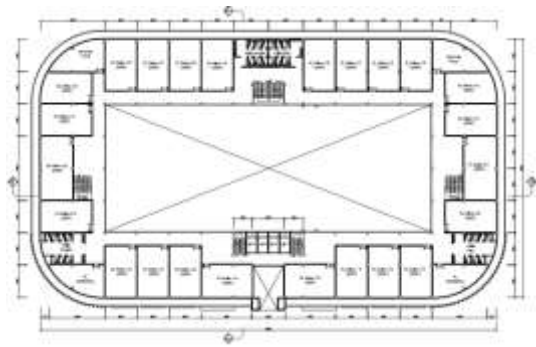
Siteplan Islamic Boarding School di Kab. Semarang
